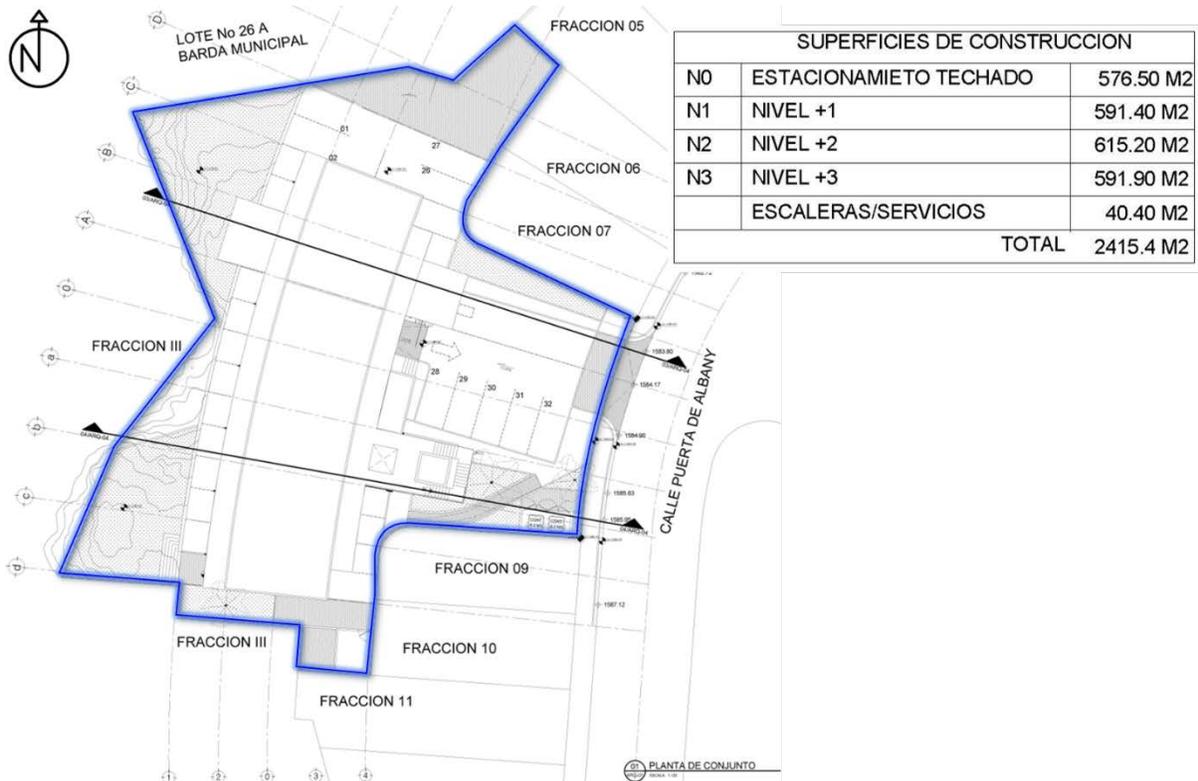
Anteproyecto conceptual de vivienda plurifamiliar. Plano de Conjunto.
